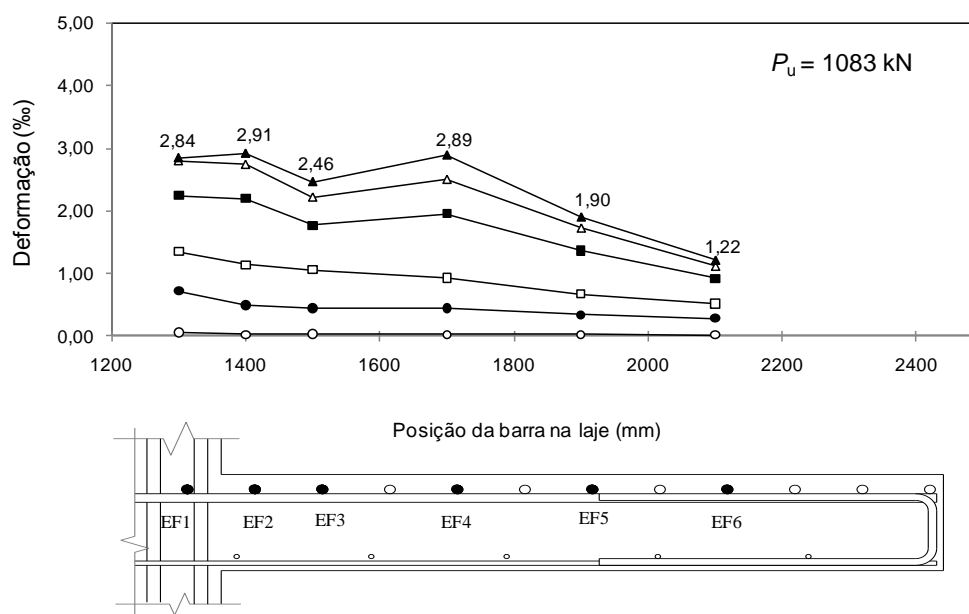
Deformações na armadura de flexão do modelo LN01.
